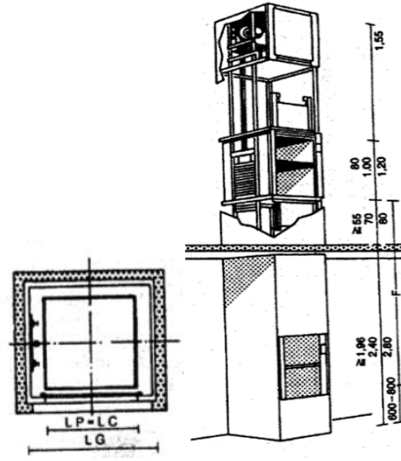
Dimensionnement d'un monte charge en plan et en coupe (source : Neufert)
